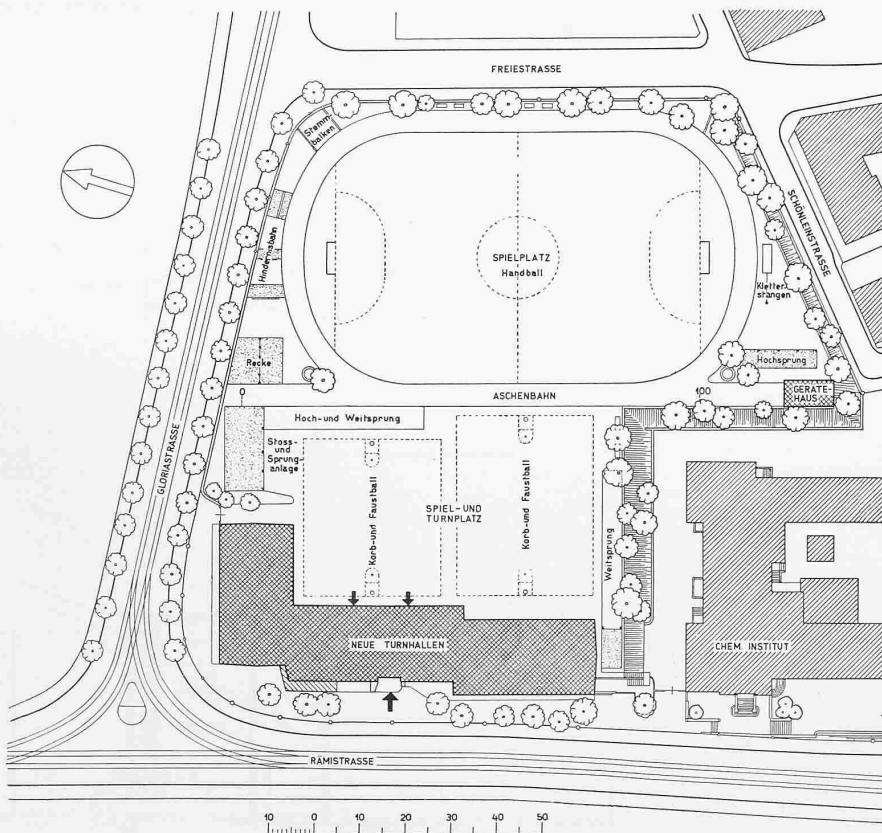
Turnanlagen der kantonalen zürcherischen Lehranstalten. — Lageplan 1:1500
